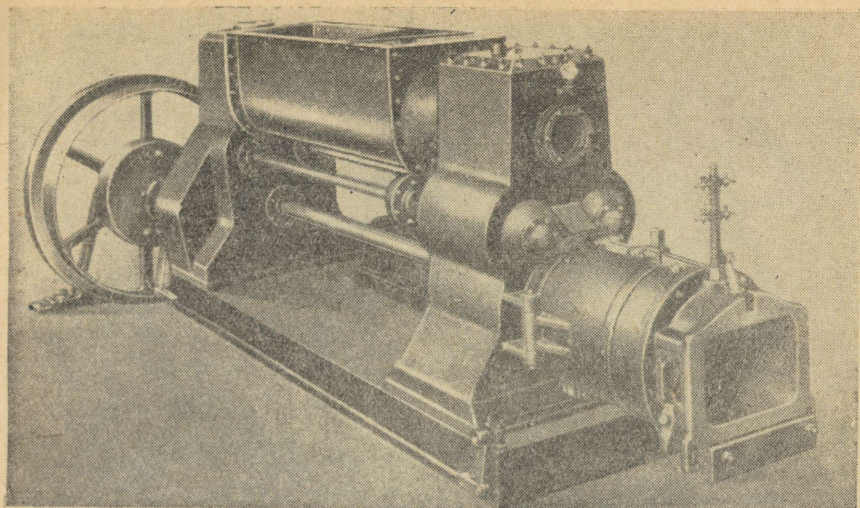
Ленточный вакуум-пресс со ступенчатым шнеком, диаметр цилиндра 350 мм.
